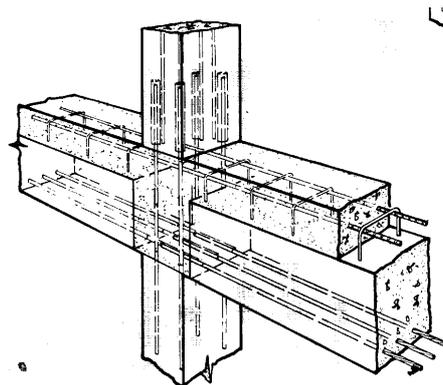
Conexión viga-columna con nudo húmedo hormigonado en 2da Etapa
